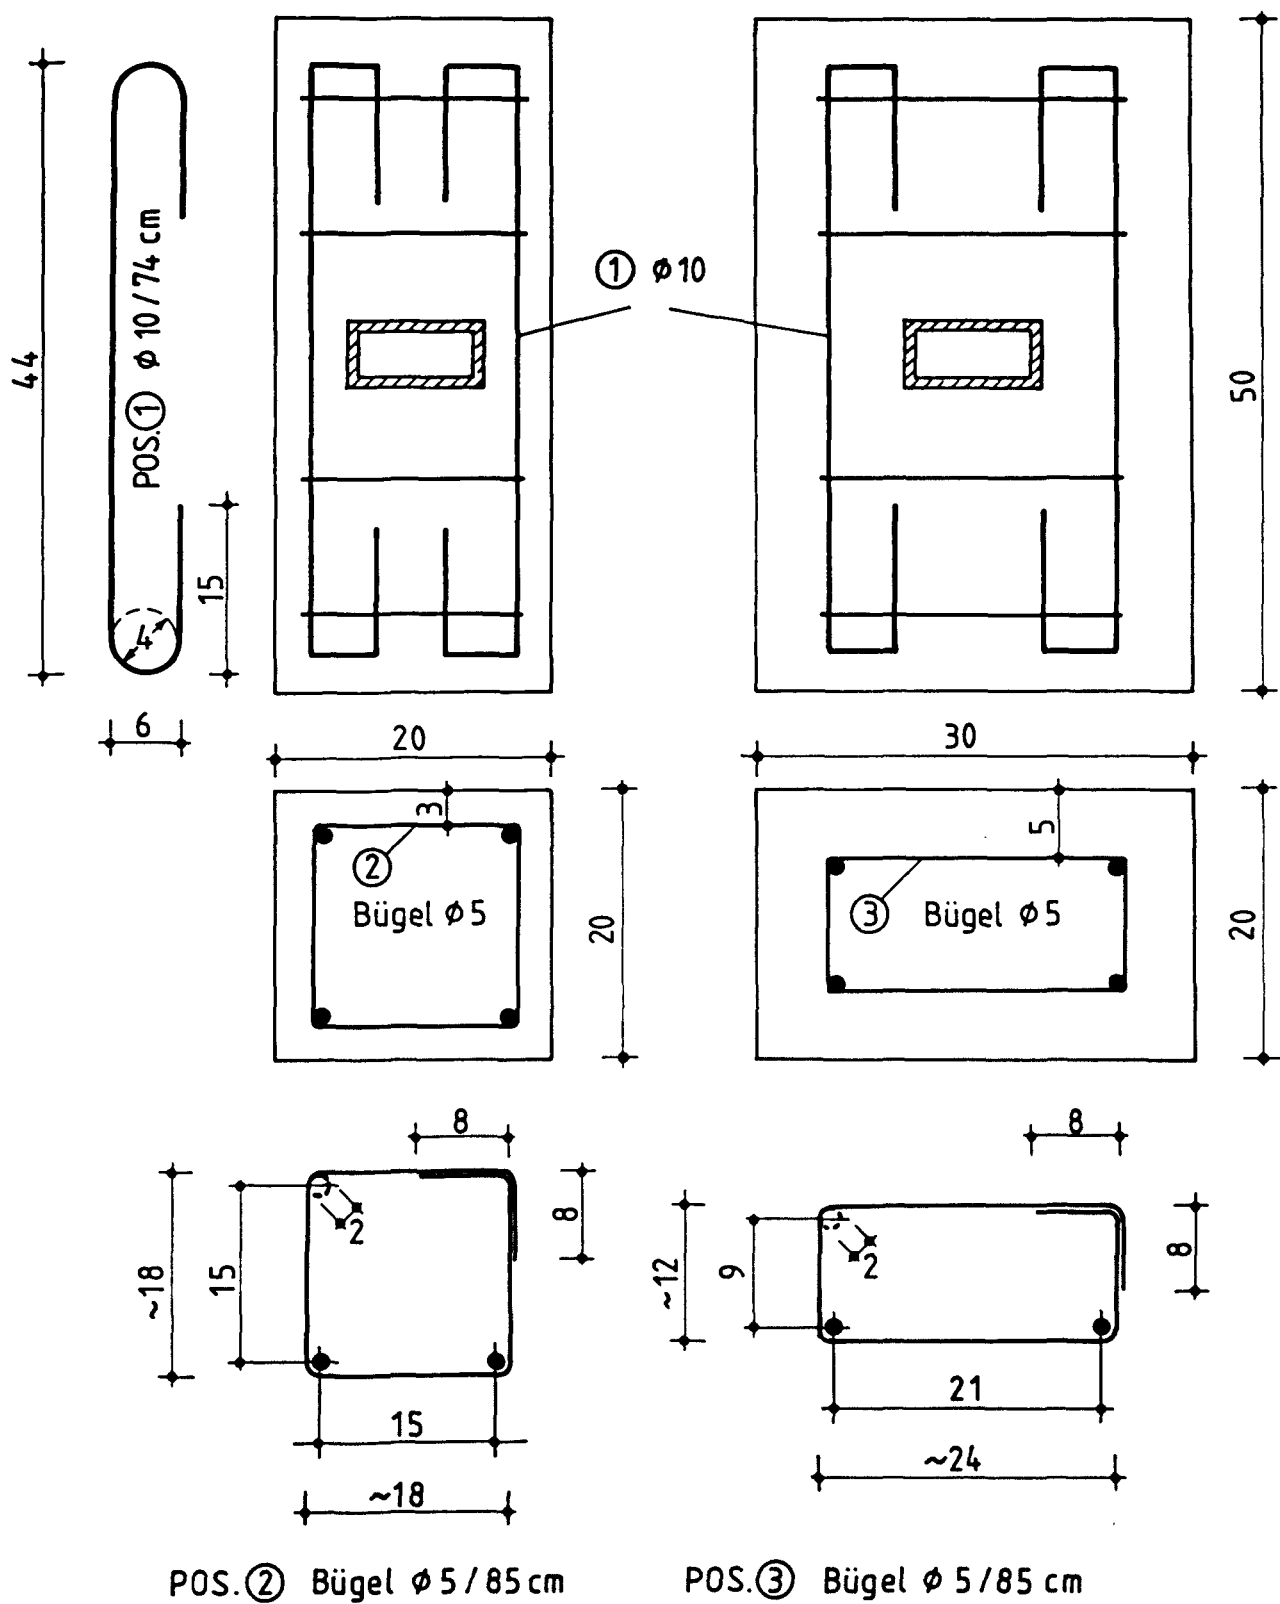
Bewehrungsplan der Stahlbetonkörper mit Vierkantrohren zur Einprägung von Trennrissen.
